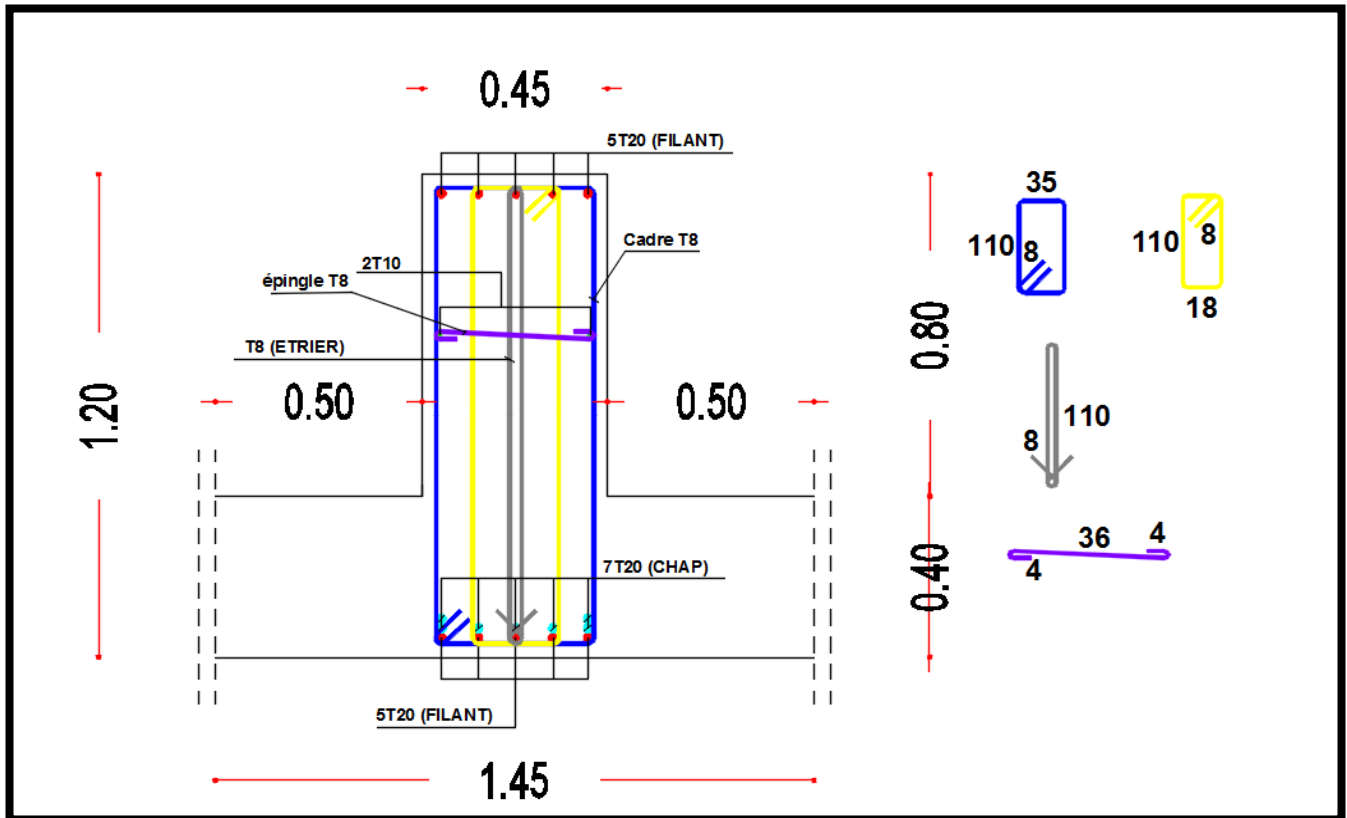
schéma de ferrailage du la poutre principale en appuis
